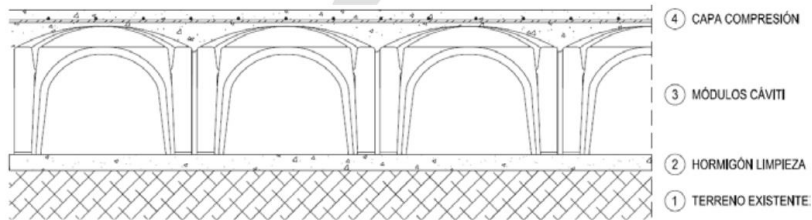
Detalle del sistema de cámara ventilada sanitaria
